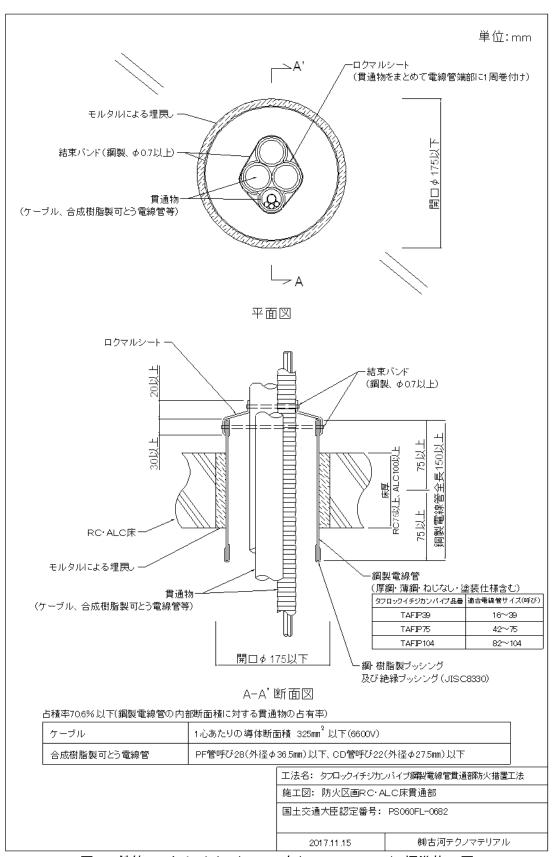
鉄筋コンクリート(RC)・ALC 床(PS060FL-0682) 標準施工図
